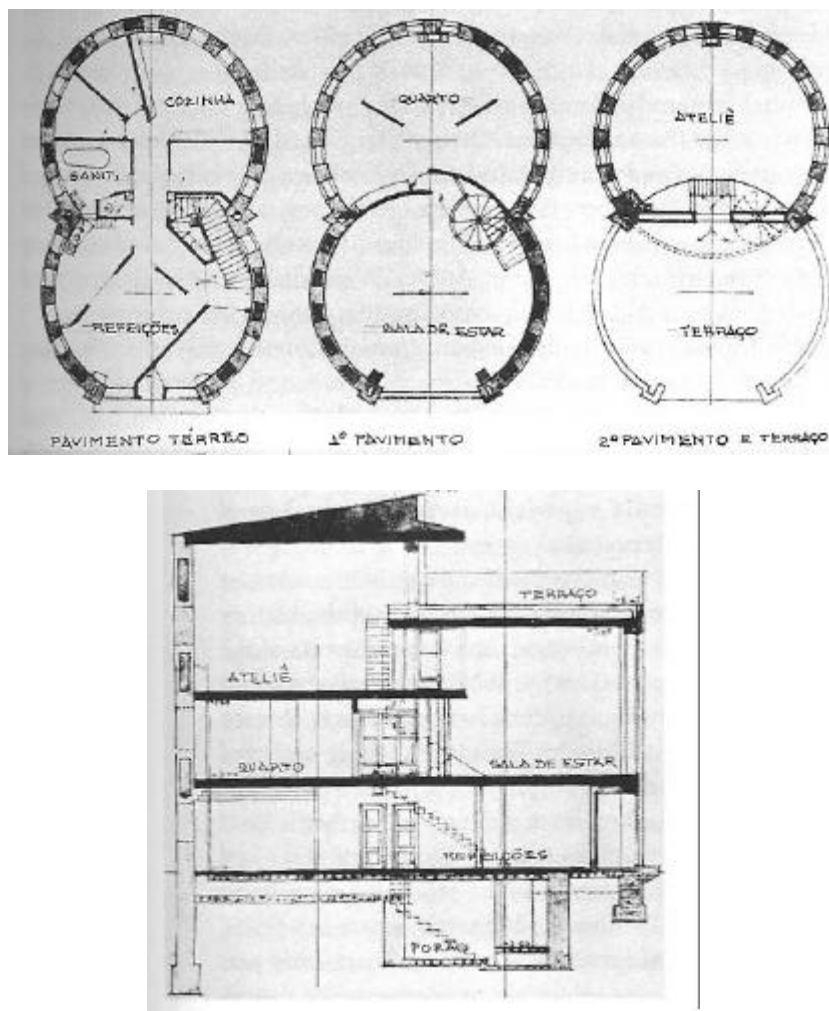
Planta baixa e corte esquemático da Casa Melnikov (1929).
